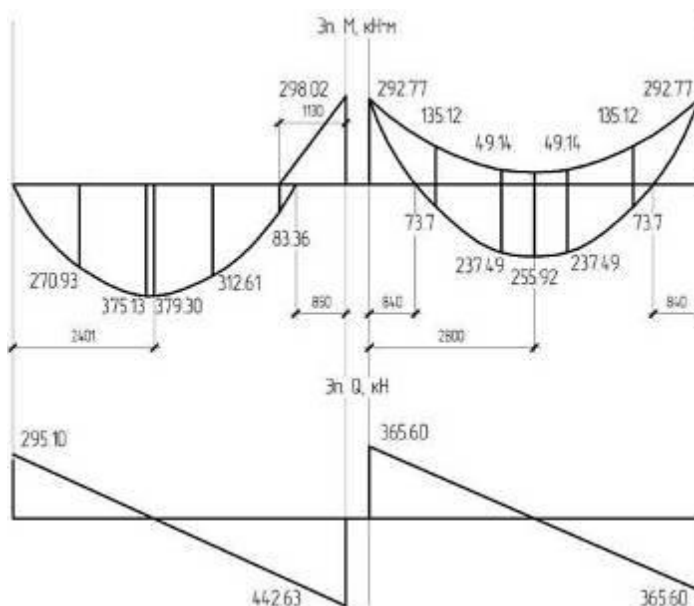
Эпюры изгибающих моментов и поперечных сил крайнего и среднего ригеля
